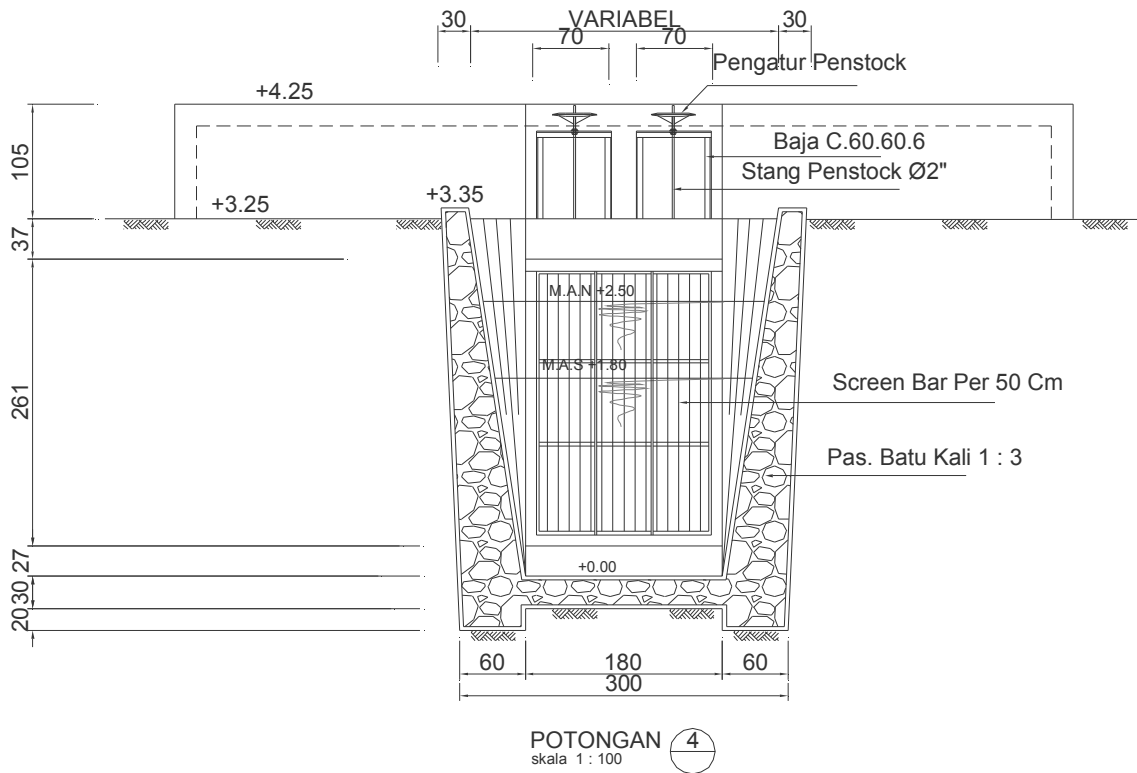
Denah bangunan pengambilan bebas dengan pintu air
